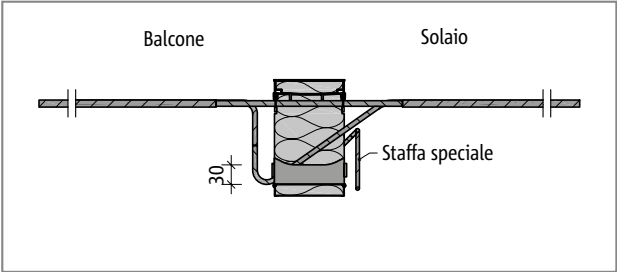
Schöck Isokorb® tipo KXT55 – KXT100: sezione dell'elemento
